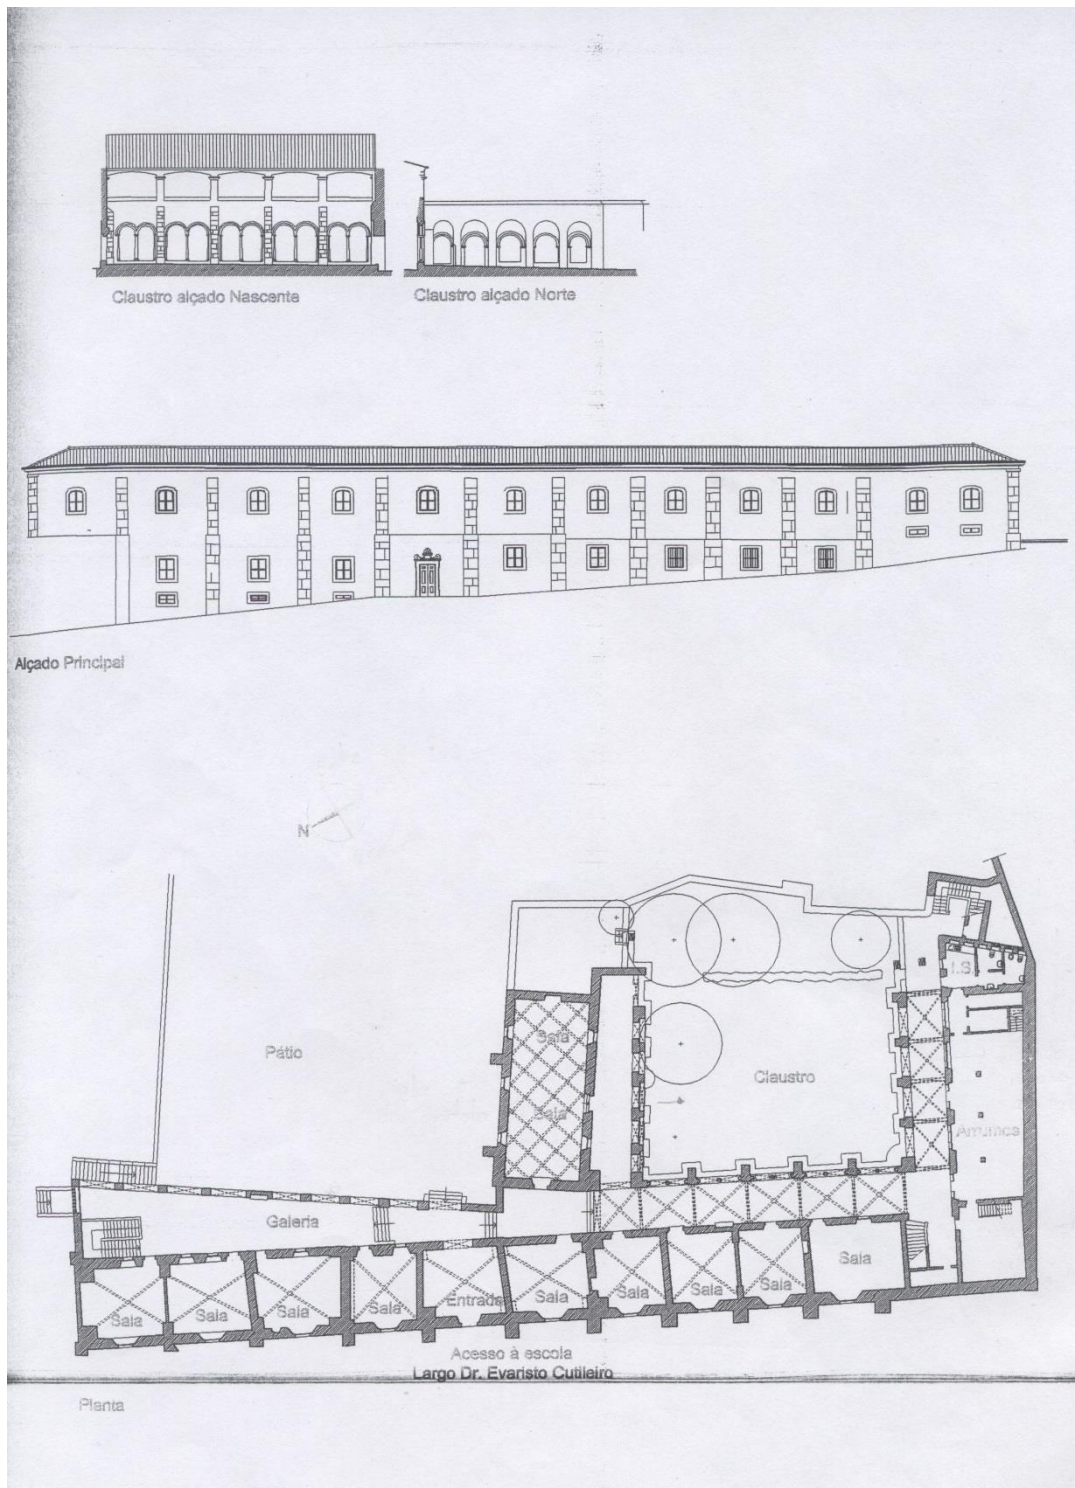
Plantas do convento de Santa Mónica (corte transversal e corte de cima).
